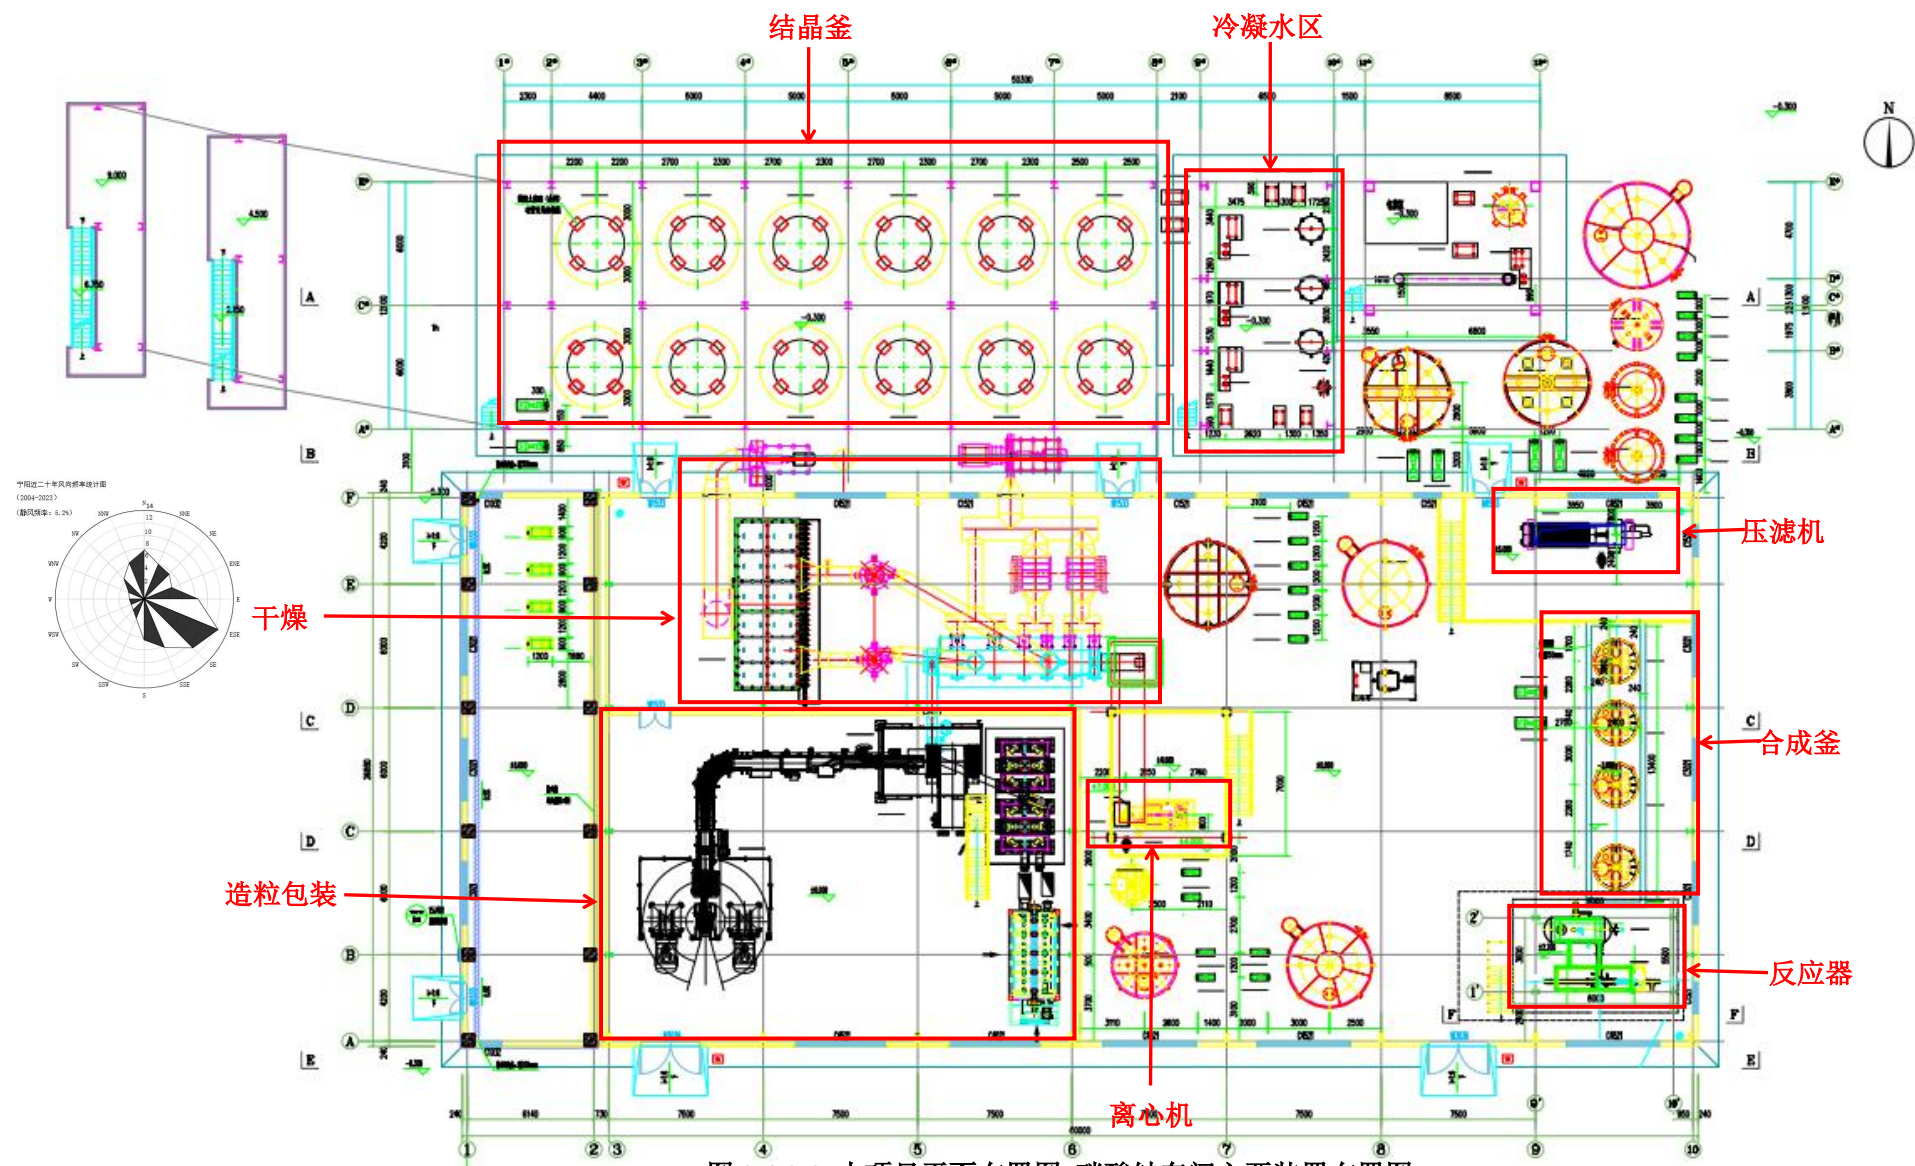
本项目平面布置图 硝酸钠车间主要装置布置图
